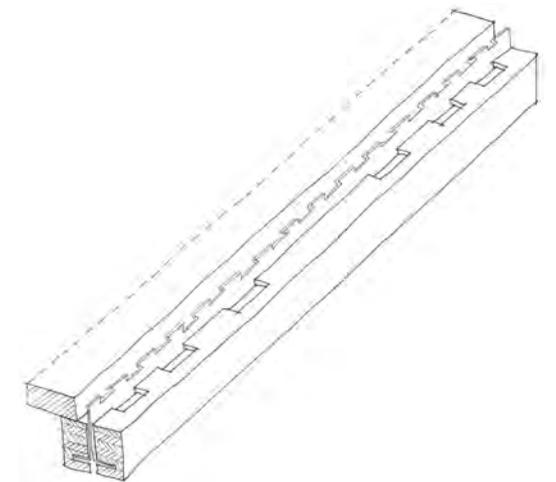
Mögliches Anschlussdetail Holz/Stahl/Beton; Grafik: ITI
